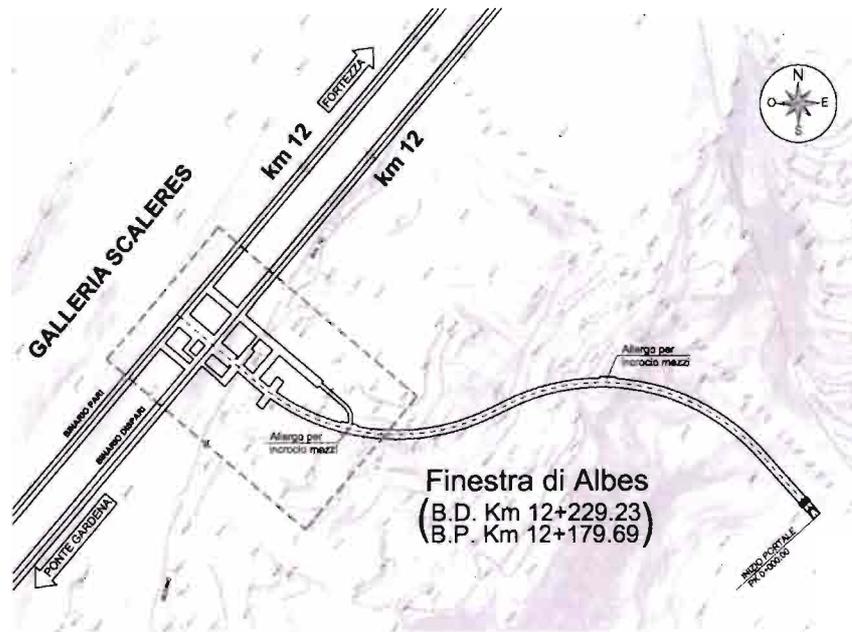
Stralcio planimetrico della finestra di Albes
